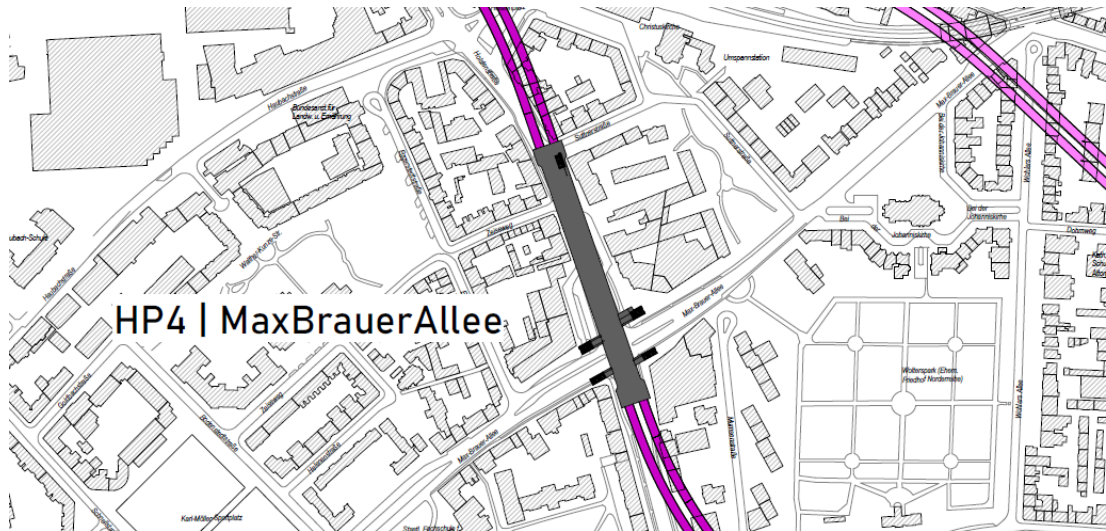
Lageplan Stationsbauwerk HP 4 Max-Brauer-Allee, Variante 2 (lila), Station I (Variantenstudie).
